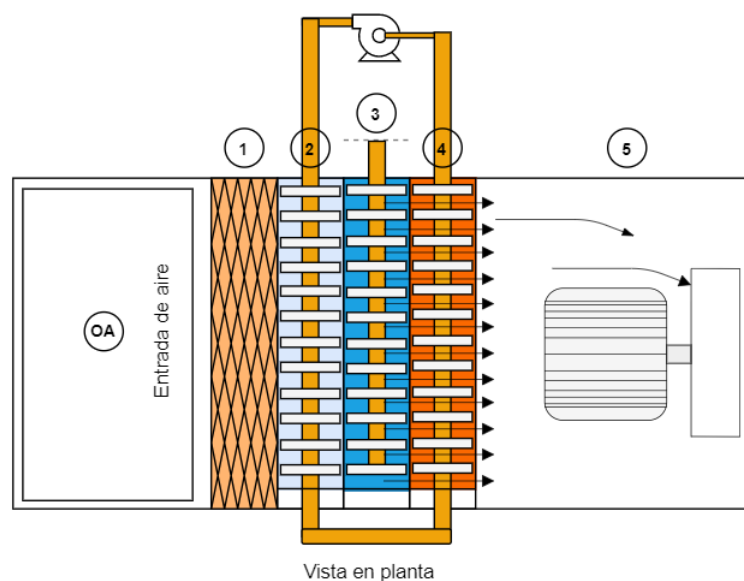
Vista en planta configuración run-around. Fuente: (Elaboración propia).
